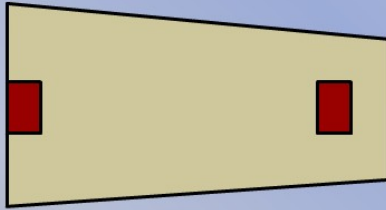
Zapata aislada de lindero y zapata aislada
